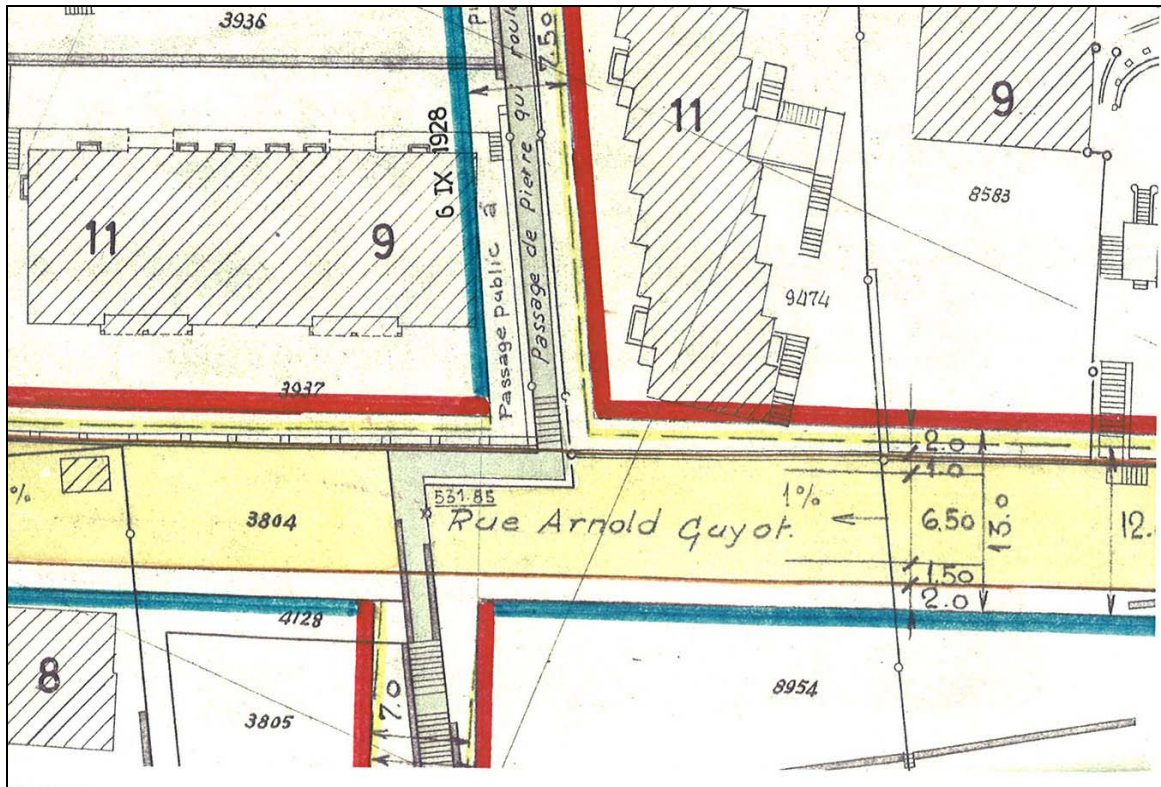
extrait du plan d'alignement n° 93 « Cassarde – Côte est – Sablons » 1968
